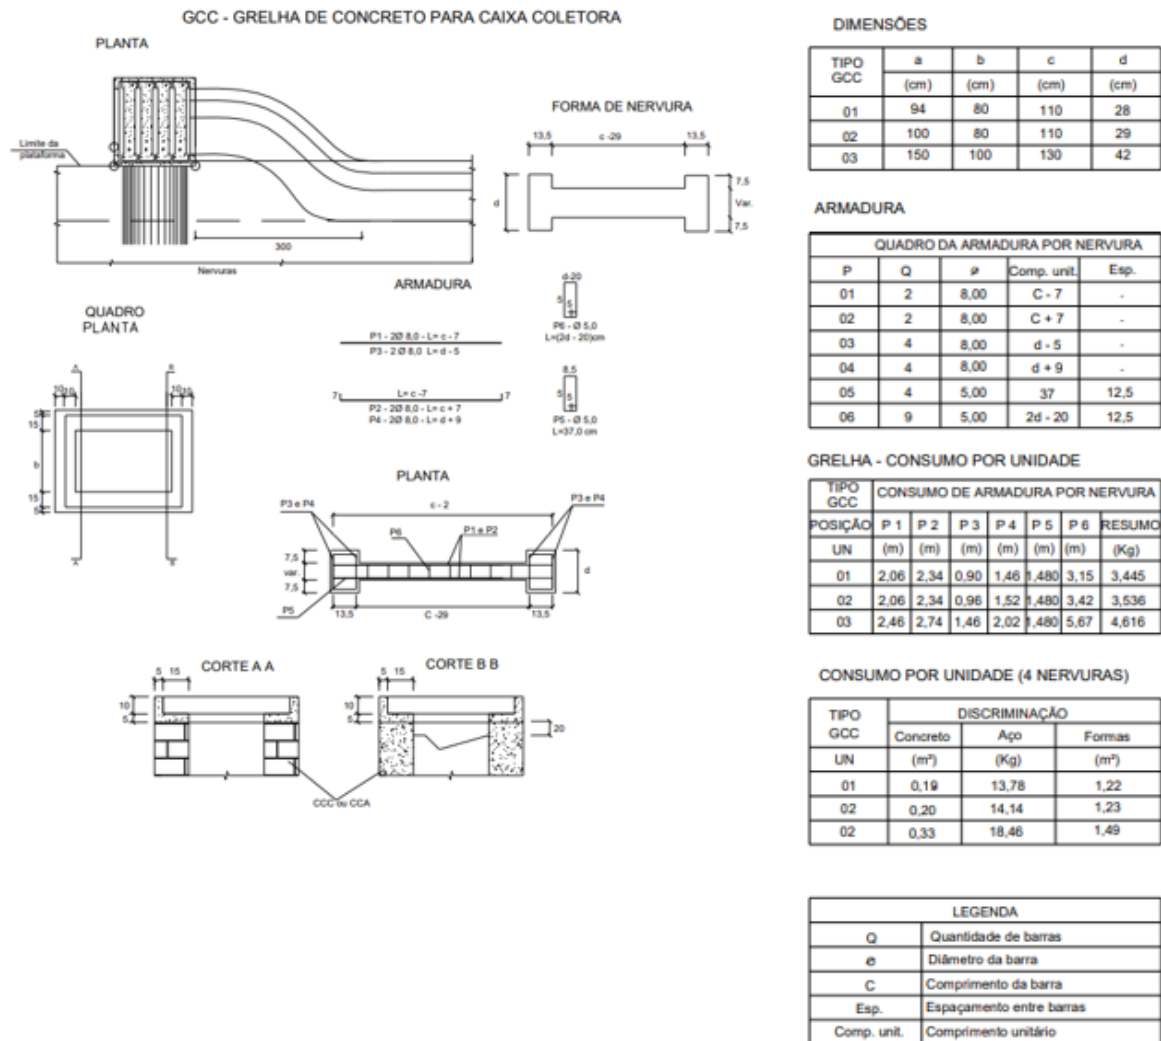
Grelha de Concreto para Caixa Coletora – GCC
